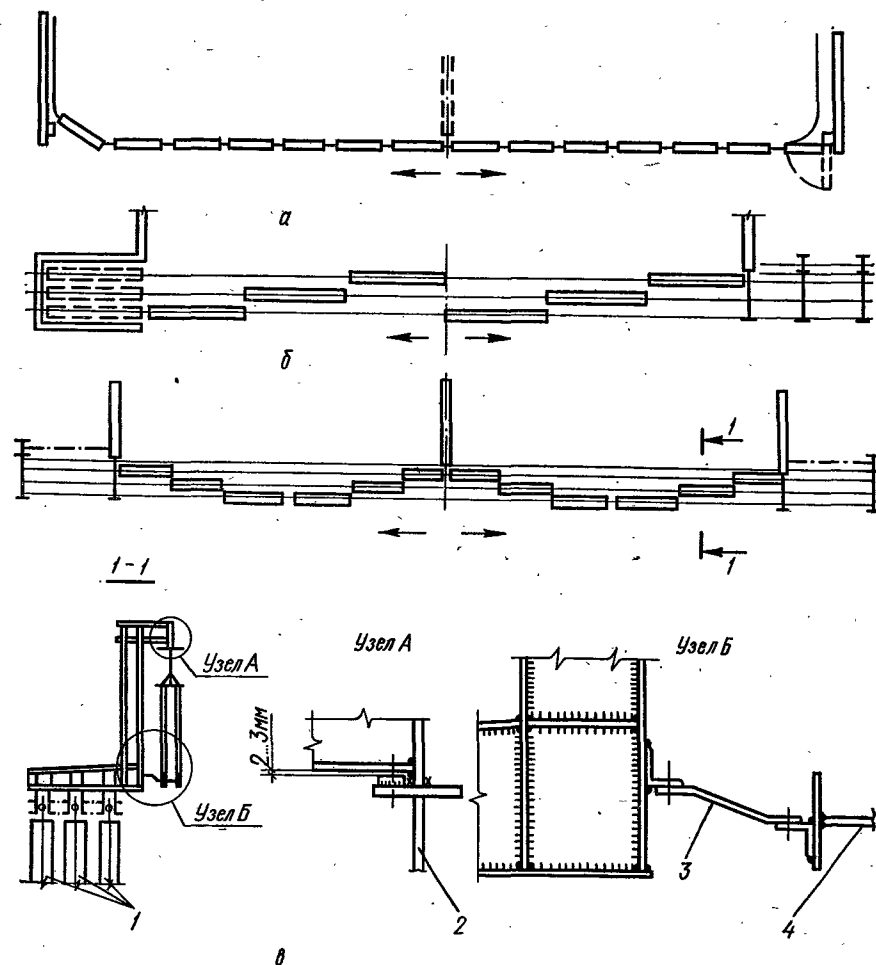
Схемы расположения створок ворот большепролетных зданий: а — закатных; б — раскатных; в — перекатных; 1 — створки ворот; 2 — верхний пояс стропильной конструкции; 3 — листовой шарнир; 4 — нижний пояс стропильной конструкции.
